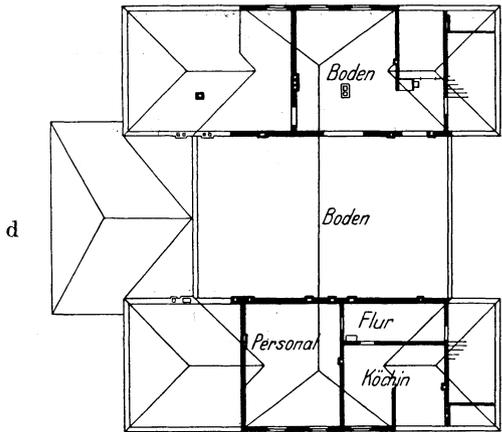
Kiel, städtisches Krankenhaus für 501 Betten, Kochhaus, Dach- und Obergeschoß.
